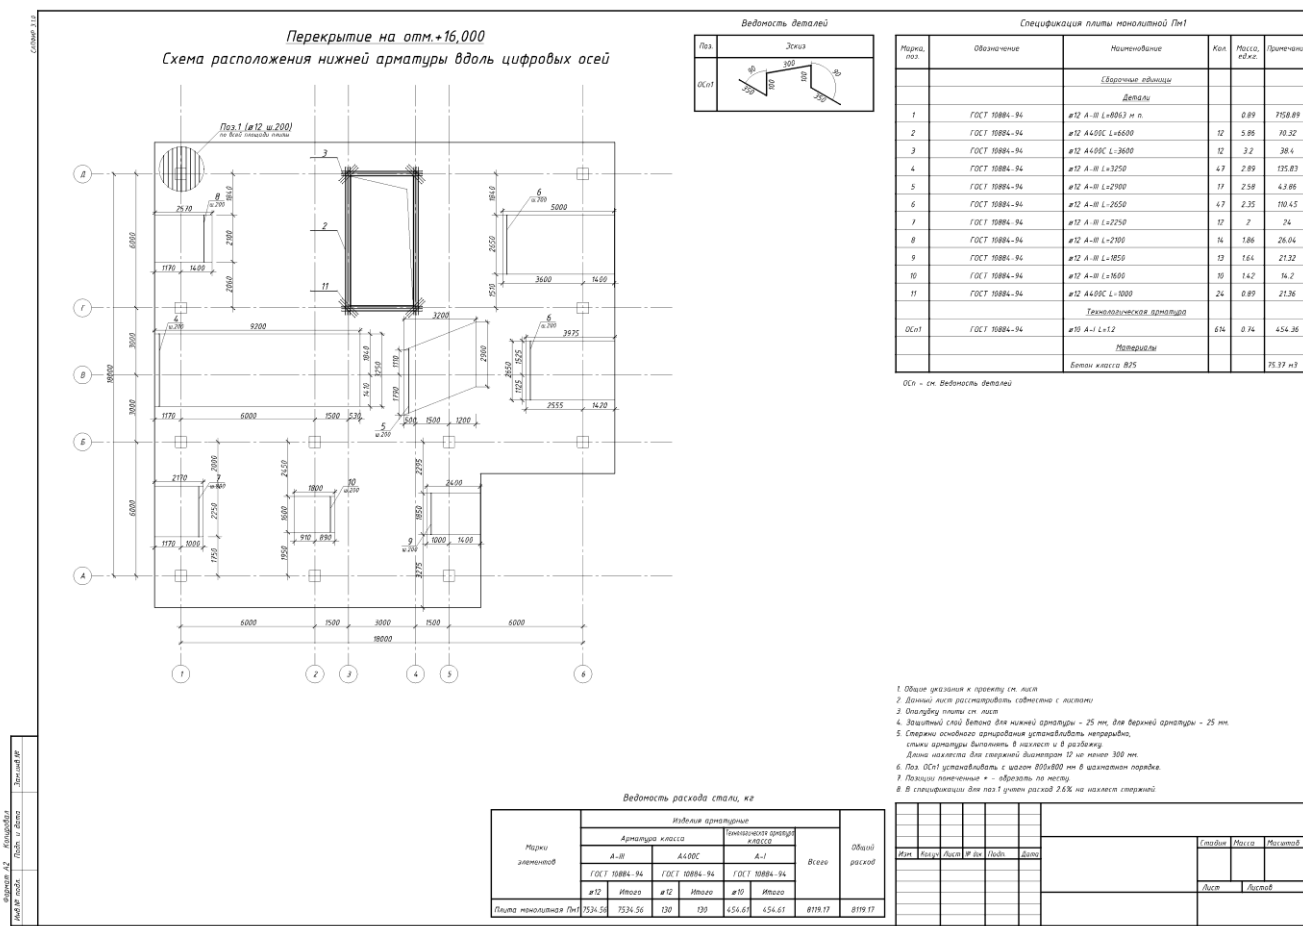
Чертеж расположения арматуры в плите перекрытия на отметке +16.000
